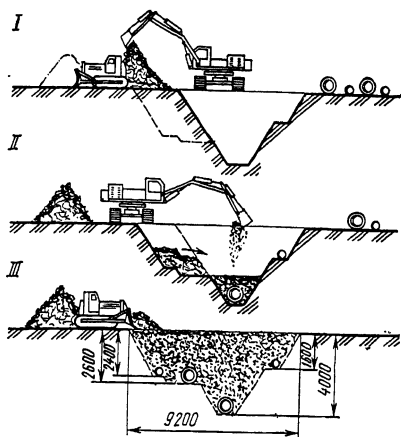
Разработка грунта в траншее при совмещенной прокладке трубопроводов:
